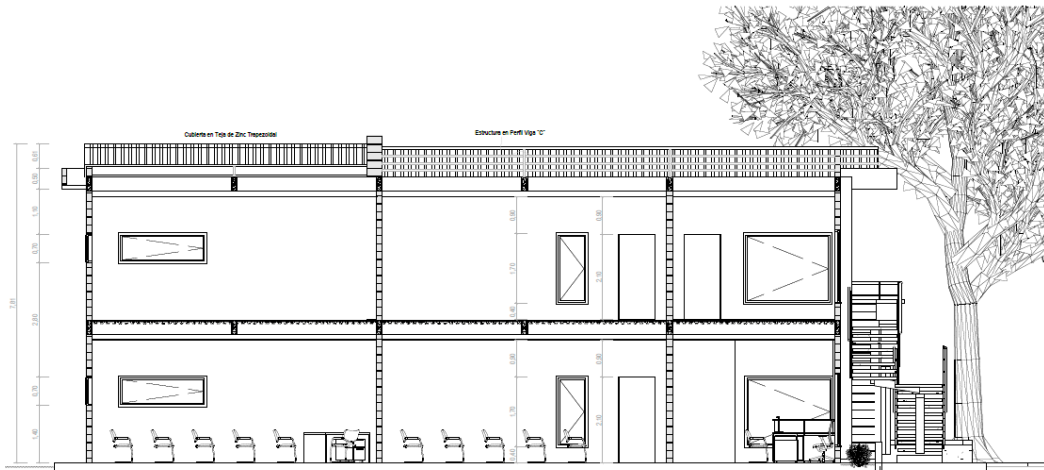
Corte Arquitectónico B-B' Actual Cafamaz.
